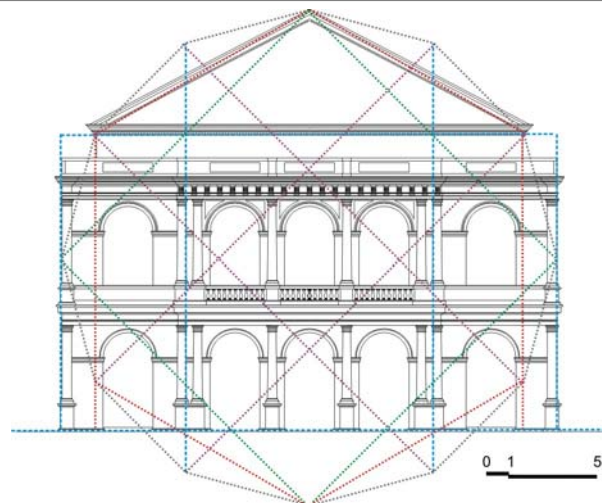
Traçado regulador da fachada em analogia com a planta baixa do Teatro, denotando total integração entre planta e elevação.
